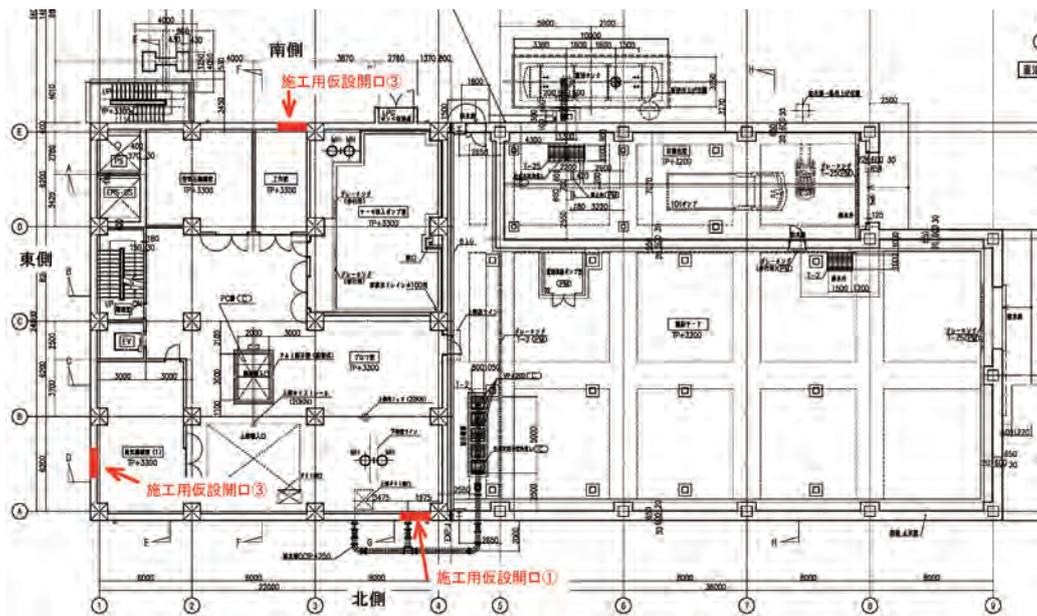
施設1階平面図(赤色部分が施工用仮設開口部)
